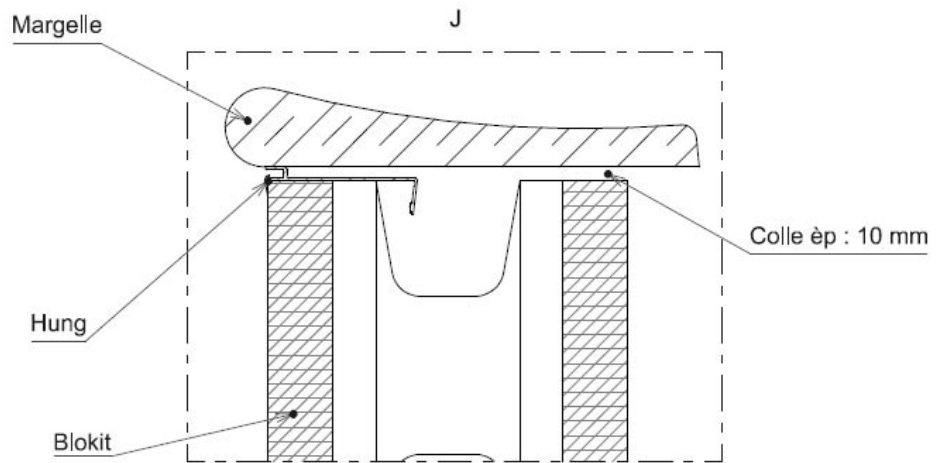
Tête de paroi avec margelle et support liner (coupe verticale d'une paroi)
